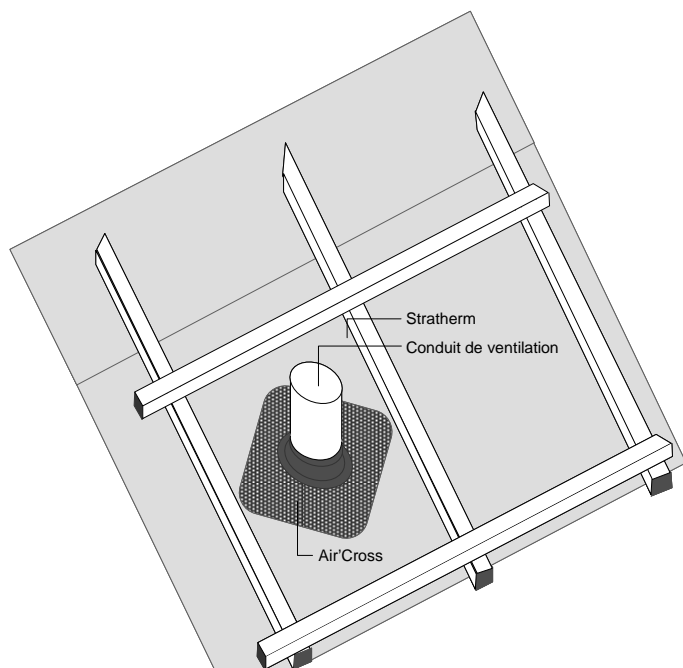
Raccordement d'une sortie de conduit de ventilation à l'aide d'une manchette Air'Cross
